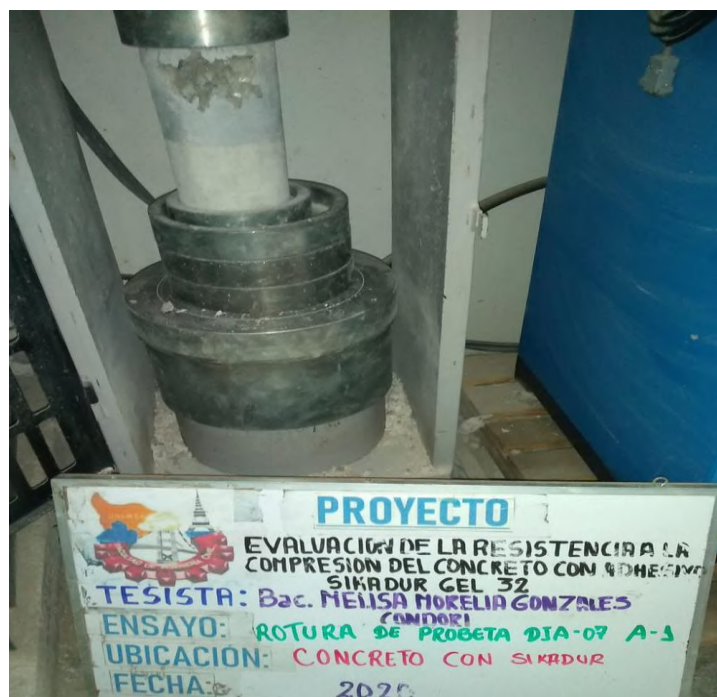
Rotura de briqueta del concreto con adhesivo con ángulo de unión de 0°
